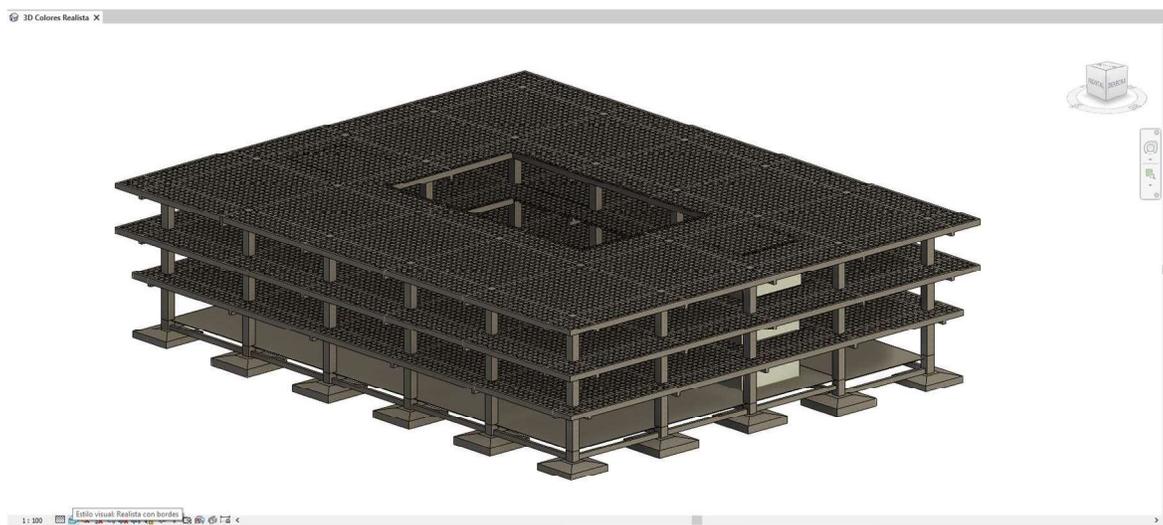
Selección de vista 3D del edificio con filtros por elementos
